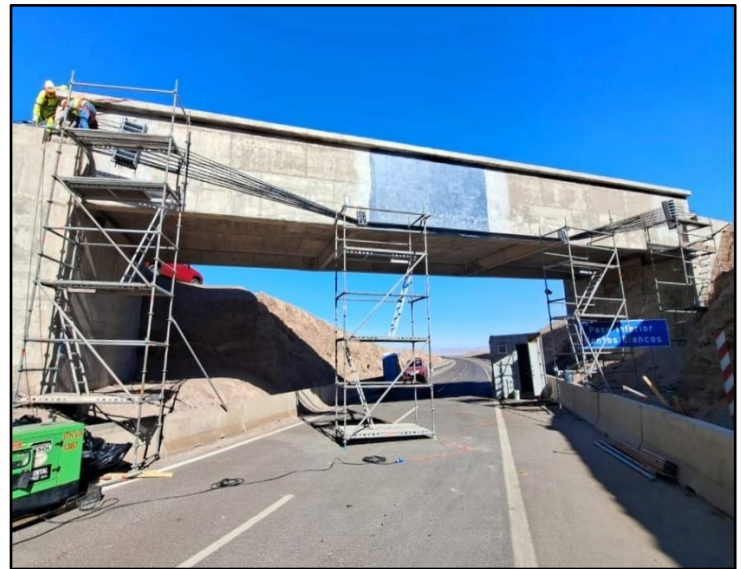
Detalle de postensado exterior y reparación con fibra de carbono. Proyecto elaborado por el autor. Foto VSL Sistemas Especiales de Construcción.
